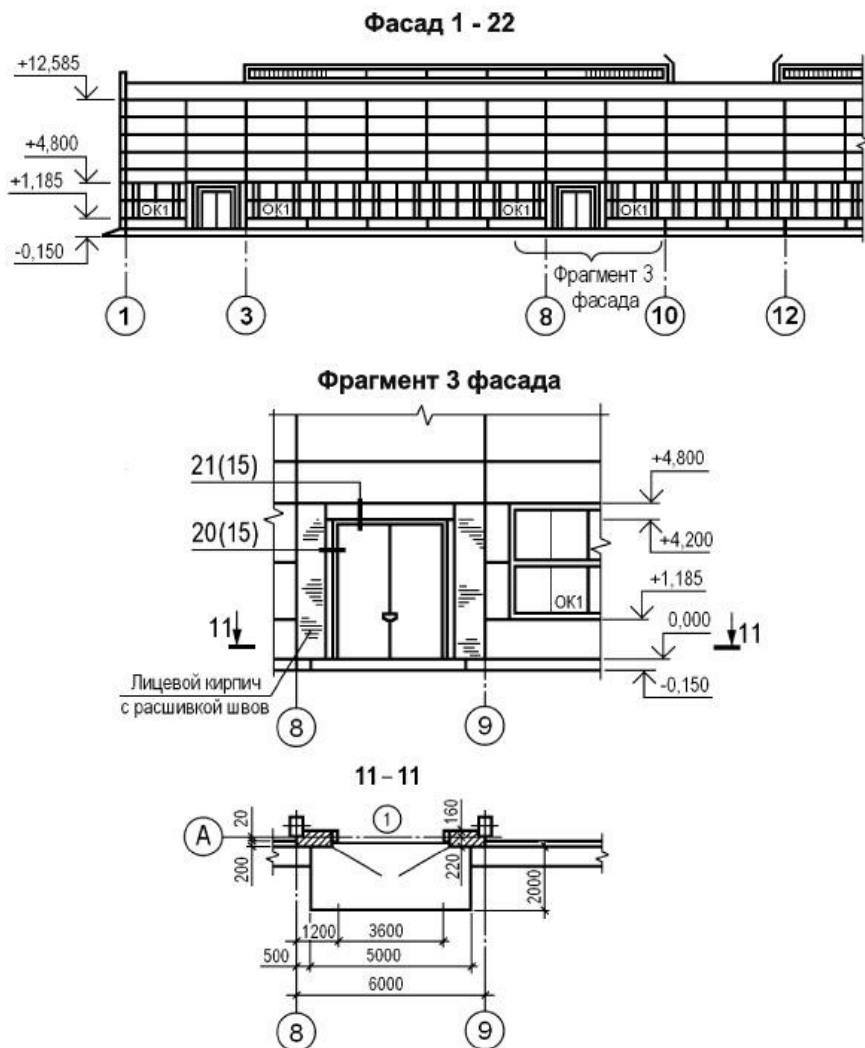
Пример выполнения фасада и фрагмента фасада одноэтажного производственного здания
